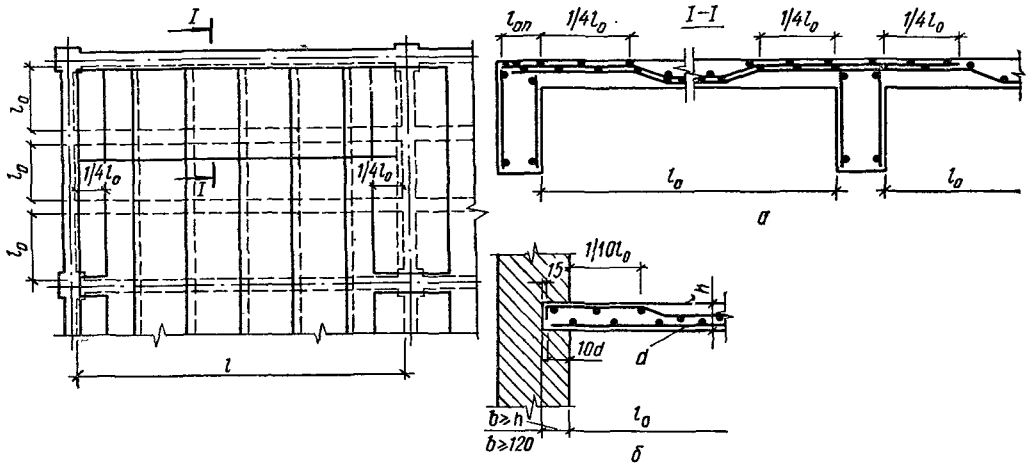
Непрерывное армирование монолитных неразрезных плит сварными рулонными сетками: а — план и разрезы плиты, опертой на железобетонные балки; б — деталь опирания плиты на кирпичную стену.
